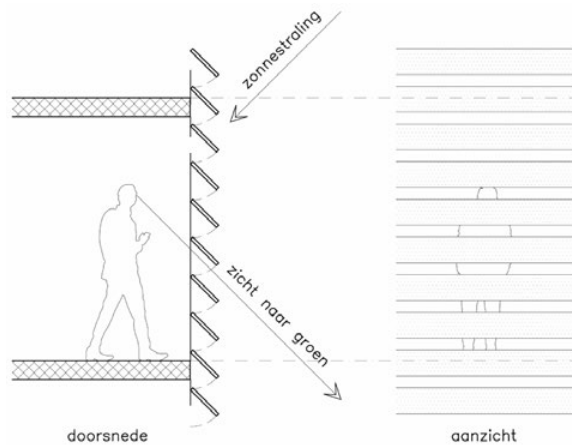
Belemmering ongewenste zonstraling met behulp van PV-lamellen.
